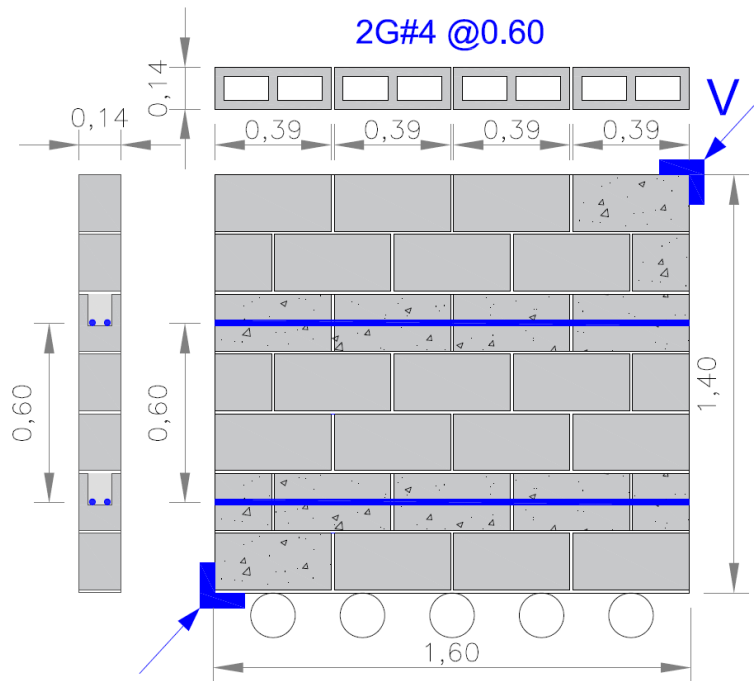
Configuración del refuerzo del muro MD-2#4/60
